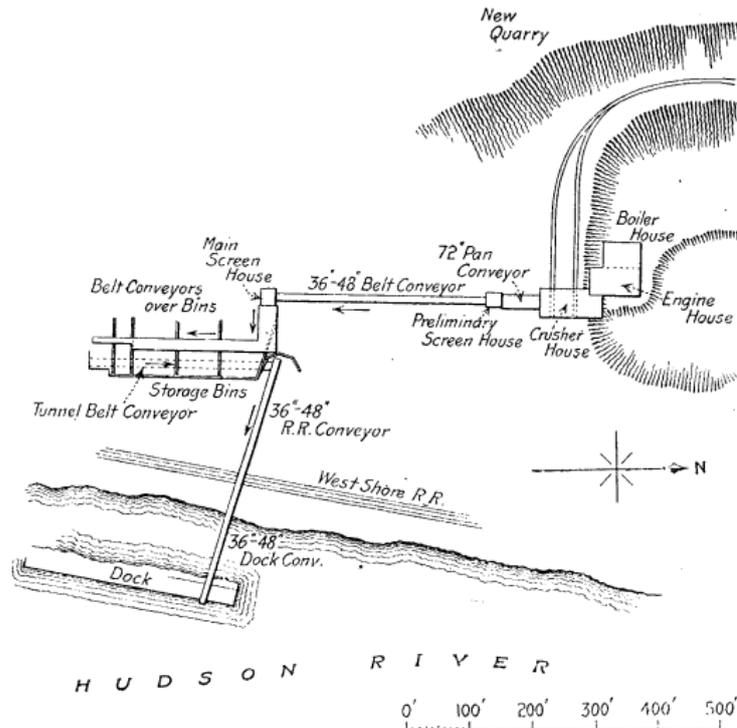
Ensemble de l'exploitation de la carrière de Tomkins.
